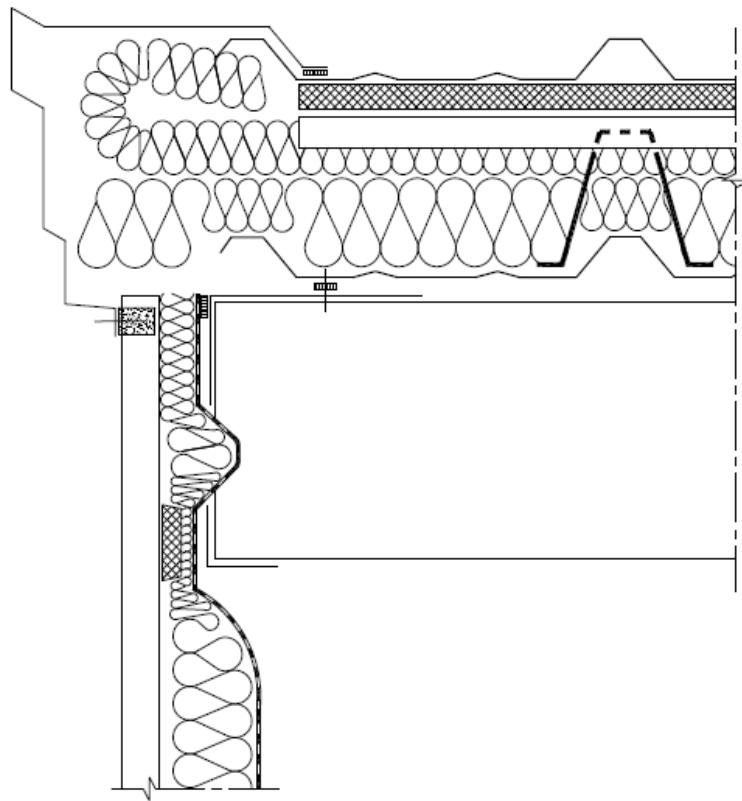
8: Beispiel für einen Dachrandabschluss, Wand aus Trapezblech, Industriedach mit Stahltrapezprofilen, als zweischalige Konstruktion
